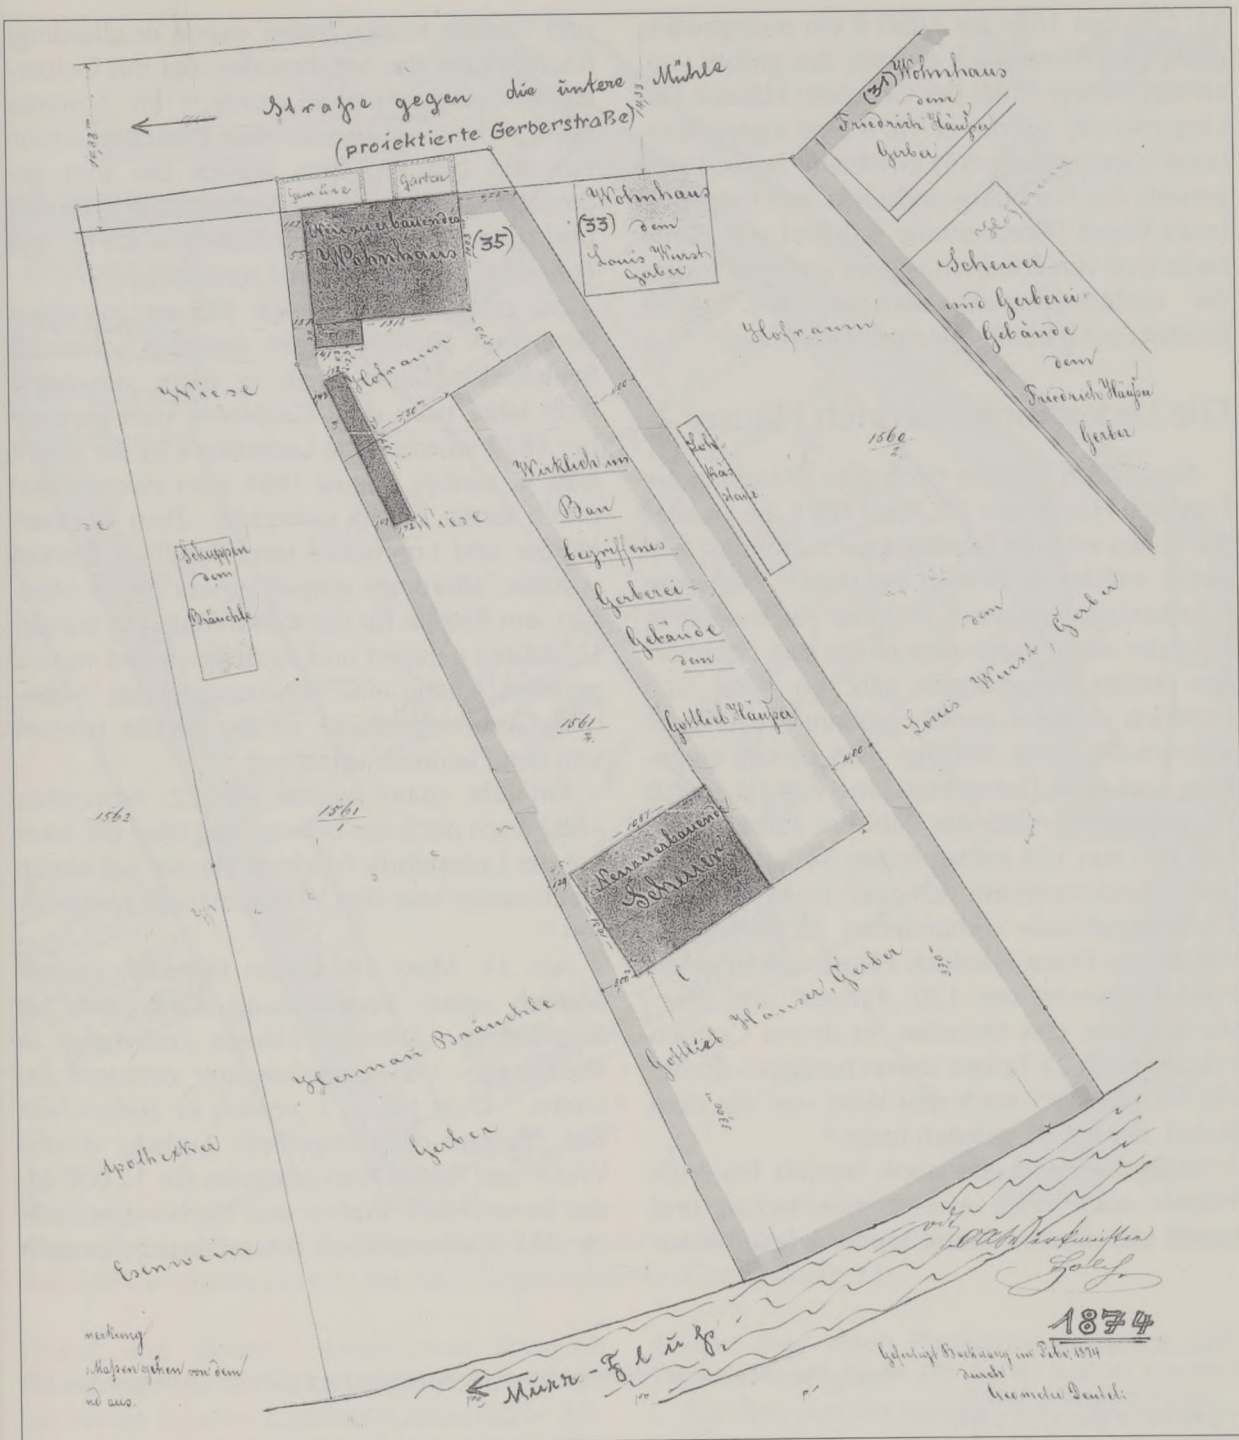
Lageplan des von Gottlieb Häuser 1873 erworbenen Grundstücks (Gerberstraße 35) mit den darauf 1874 errichteten Wohn- und Gerbereigebäuden.
